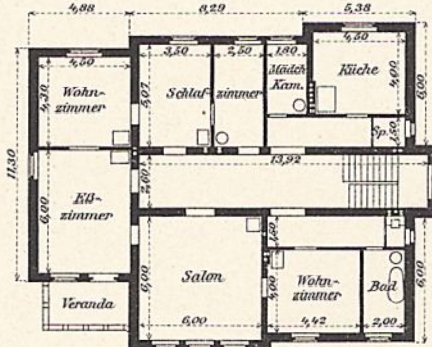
Beamtenwohnhaus. (B u. E im Lageplan Abb. 13.)
